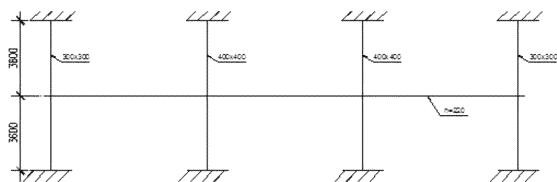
Конструкция и расчетная схема монолитного перекрытия в направлении буквенных осей
